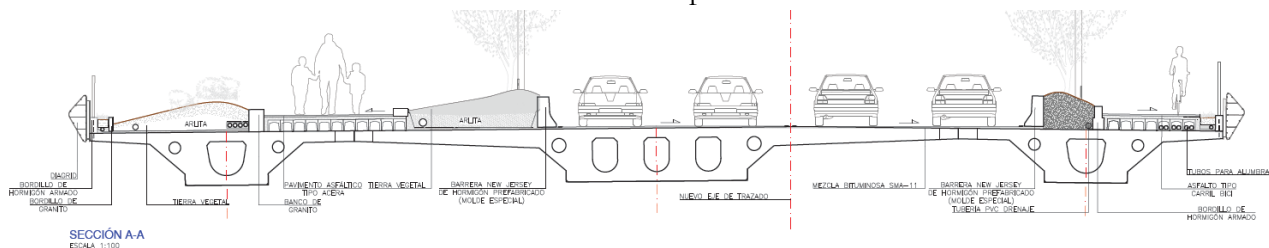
Sección tipo del nuevo puente de Pedro Bosch
